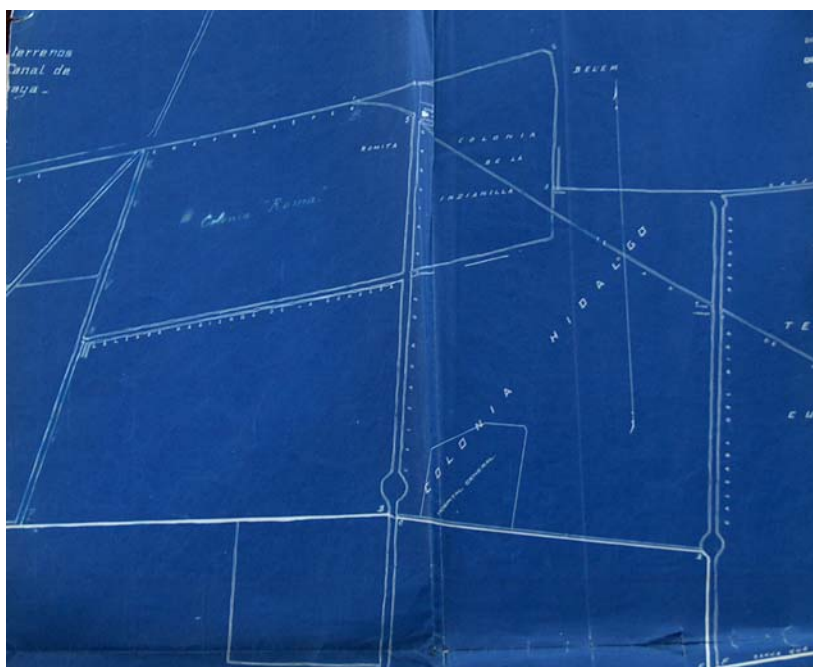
Plano del proyecto de saneamiento elaborado por Roberto Gayol. Se propone la elaboración de un canal por la avenida Chapultepec que posteriormente en el extremo nororiente se une con el Canal de la Derivación. AHDF. Ramo Ayuntamiento, Sección Colonias, Volumen 19. Expediente 25.
